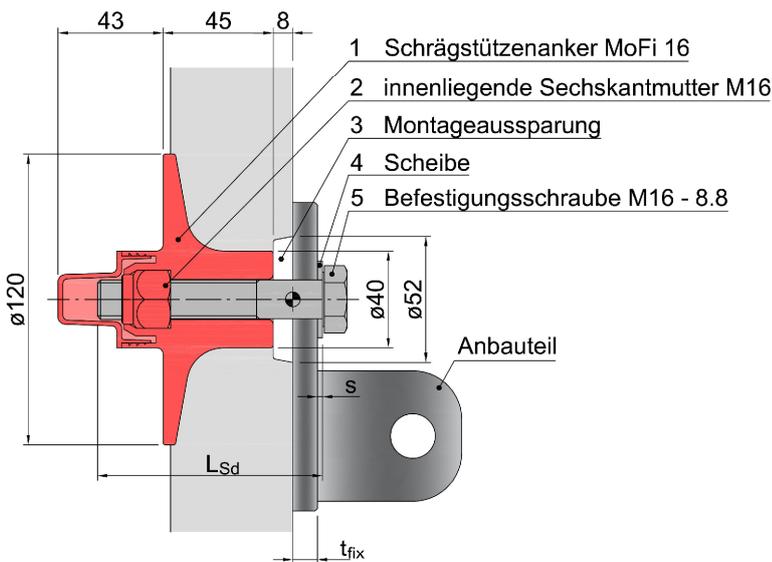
Bezeichnungen, Abmessungen MoFi 16
